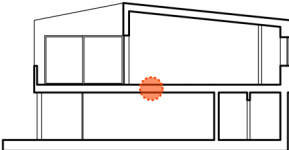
Deckenkonstruktion | Variante 01 und 02 | M 1:10
